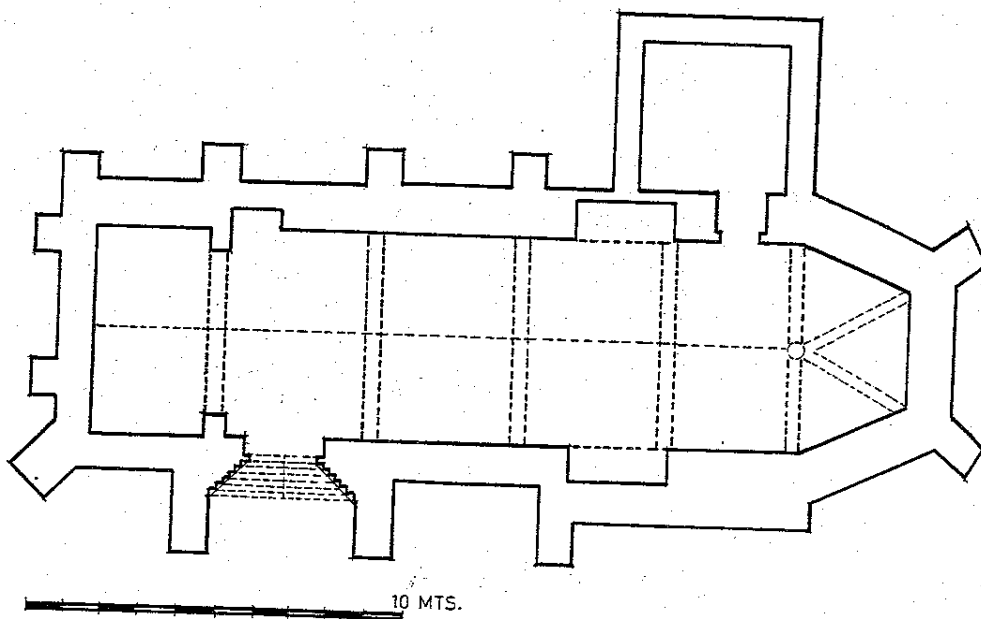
LARRAGUETA. Parroquia de San Esteban.
